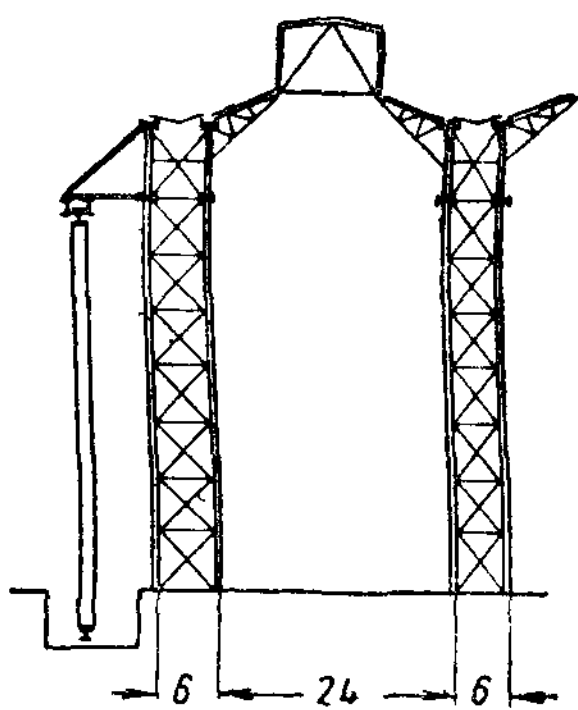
Консольная система покрытия над судовой палубой
